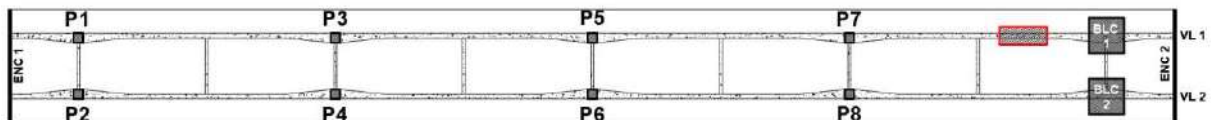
Fissura e recalque nas cabeceiras da ponte.
